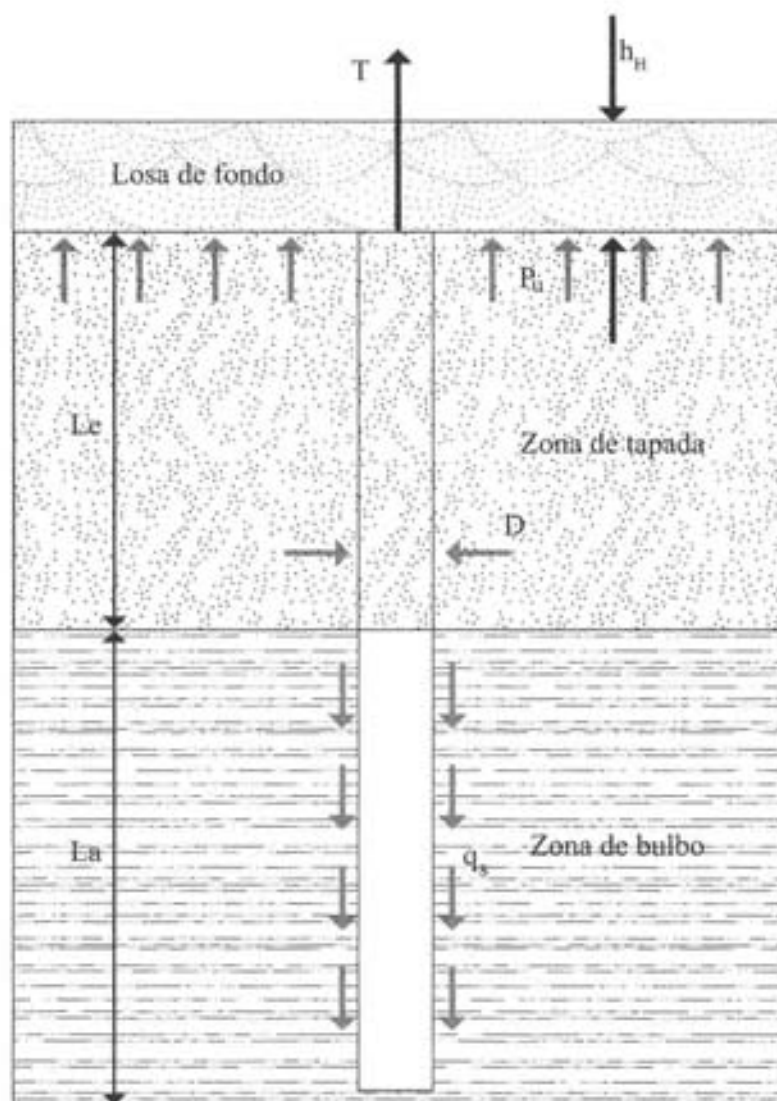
ESQUEMA DE CÁLCULO ALTERNATIVO DE ANCLAJE PARA LOSA DE SUBPRESIÓN
